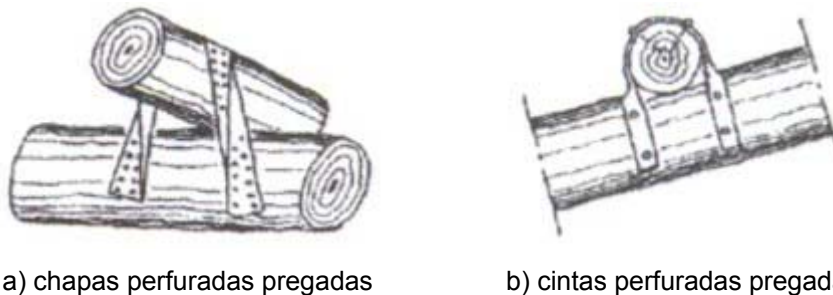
Conectores de chapas metálicas galvanizadas perfuradas. a) Ligações de topo viga-viga, inclinadas; b) Ligações coluna-viga inclinada. Fonte: www.gangnail.com.br
